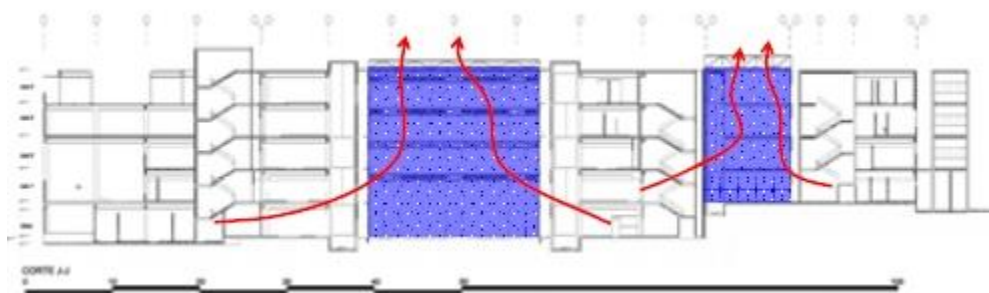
Falso cielo ventilado. Fuente: Arq. Javier Caravedo
